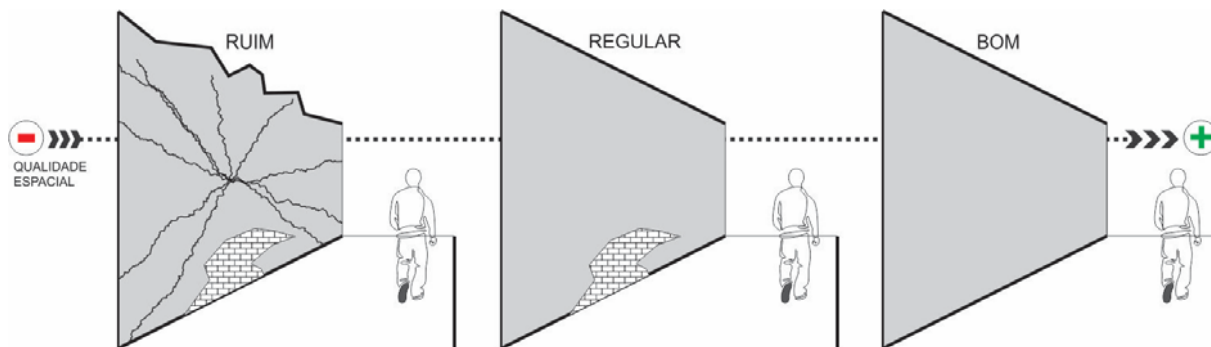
Configuração – borda: 1º plano – EDIFICAÇÃO: ESTADO DE CONSERVAÇÃO
